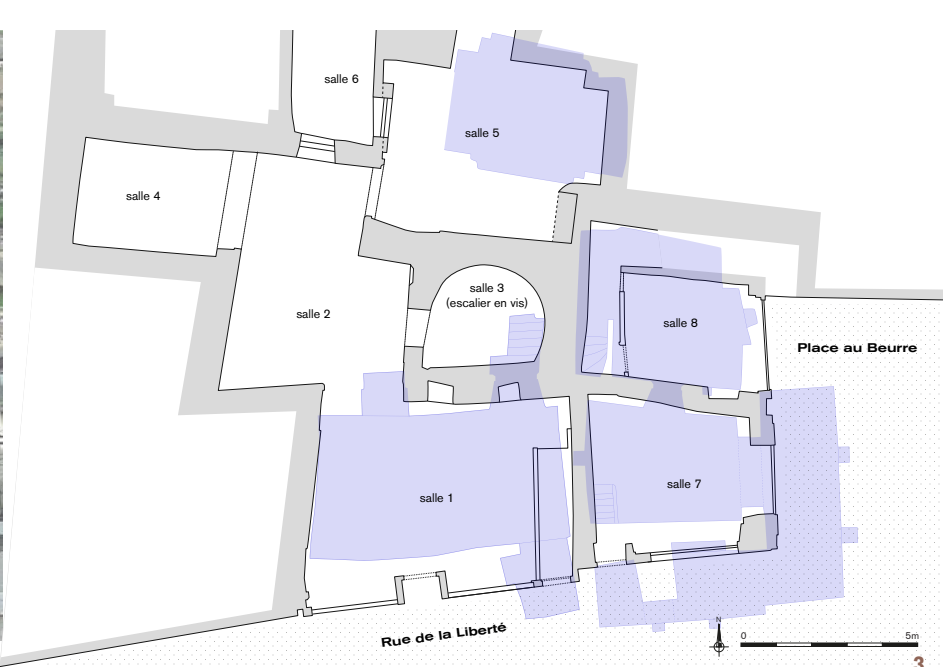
Plan du rez-de-chaussée (en gris) et des caves (en bleu). Sous la salle 7, la cave déborde sous la rue de la Liberté et sous la Place au Beurre.
